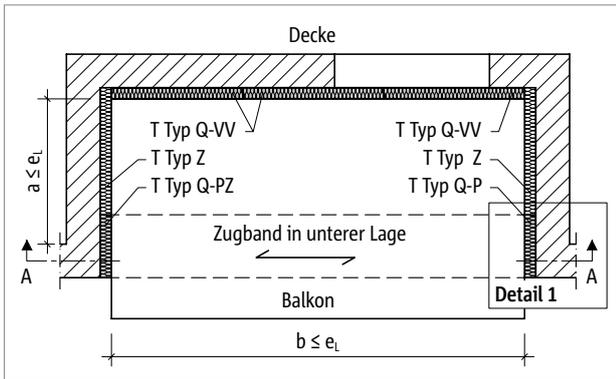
Schöck Isokorb® T Typ Q-PZ, Q-P: Grundriss Loggia
